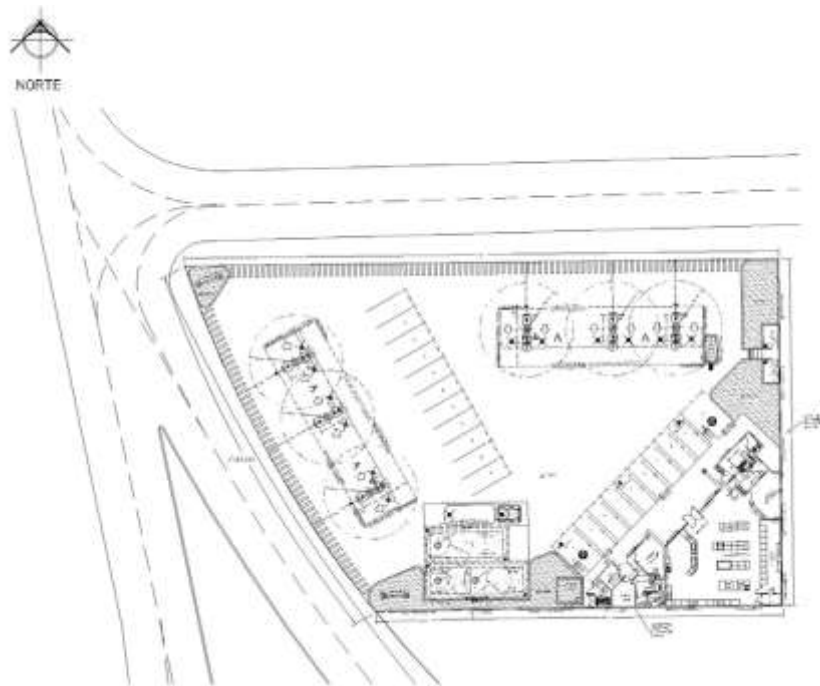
Vista superior del proyecto extraída de los planos civiles.
